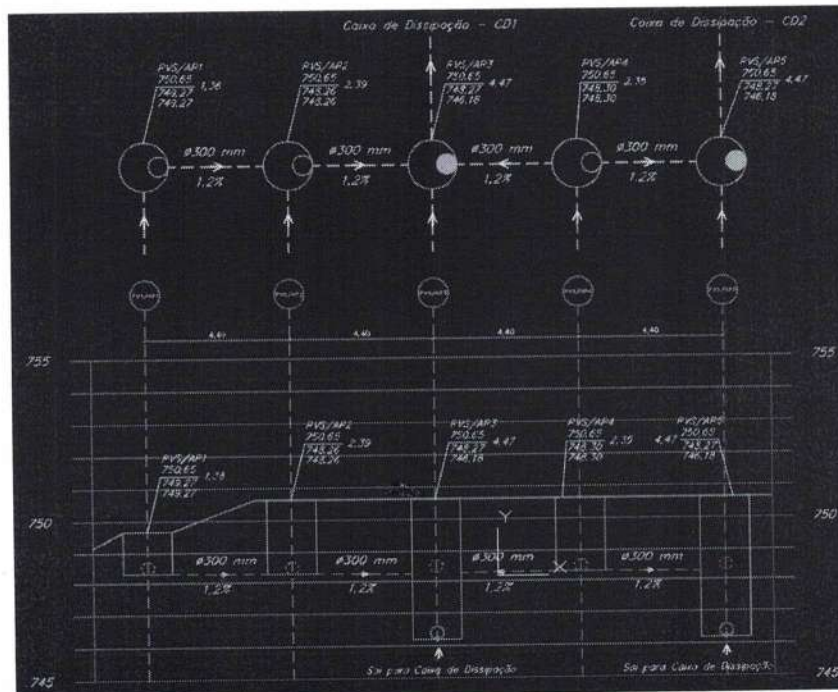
Detalhe do Sistema de Retenção de Águas Pluviais - Reservatórios
